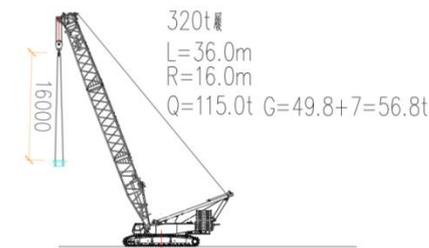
P109-110 双 T 梁履带吊吊装工况立面图
